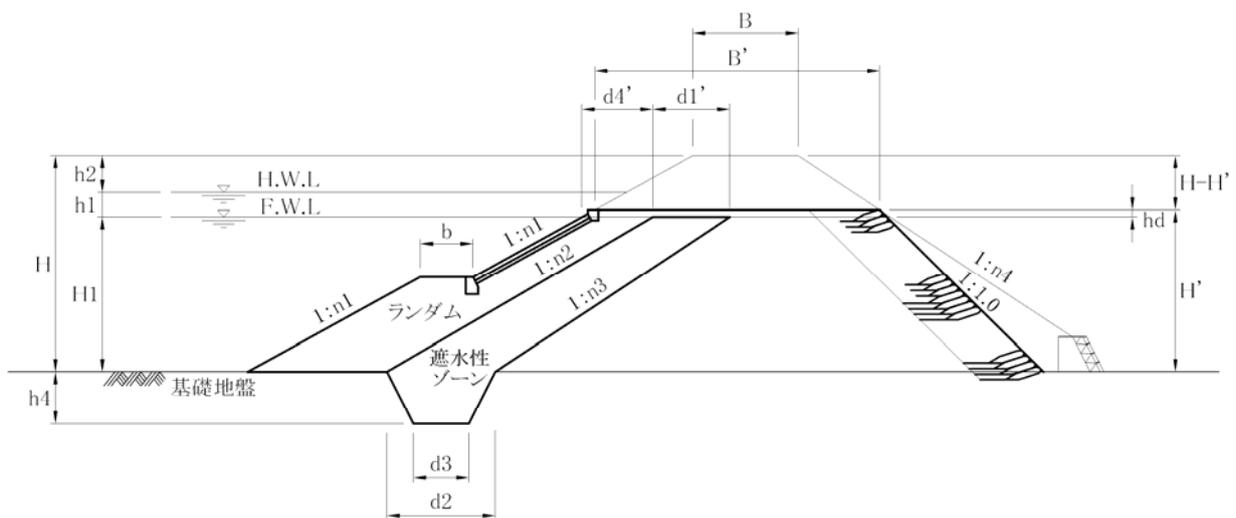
越流許容範囲（傾斜遮水ゾーン型）の標準断面
